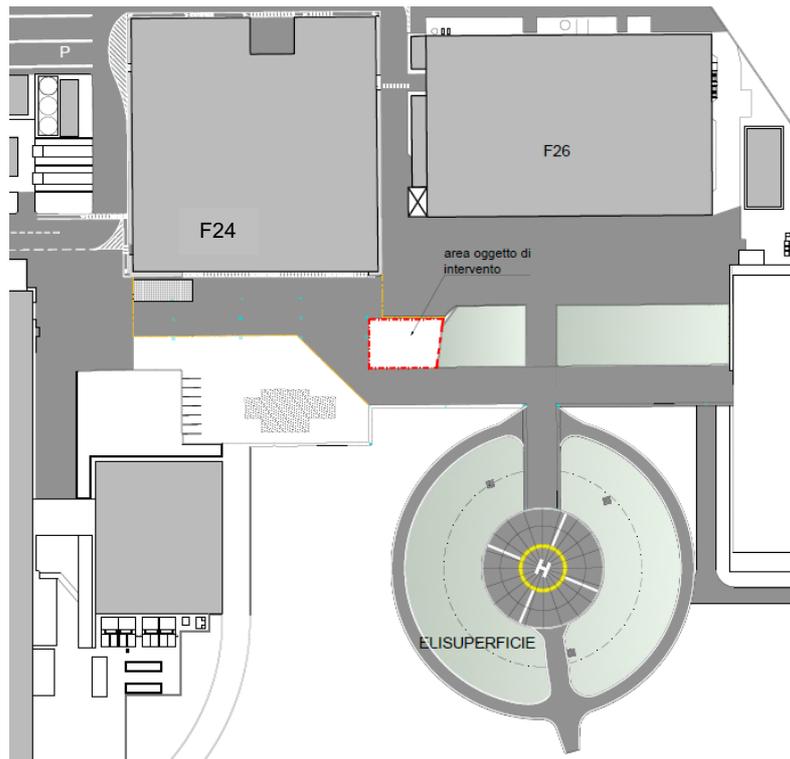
Stralcio di planimetria con identificazione area di gestione carburanti
